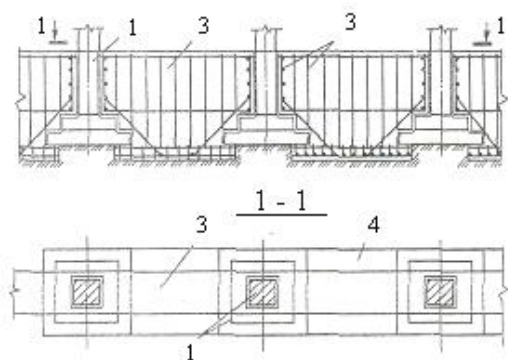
Переустройство столбчатых фундаментов в ленточные:
